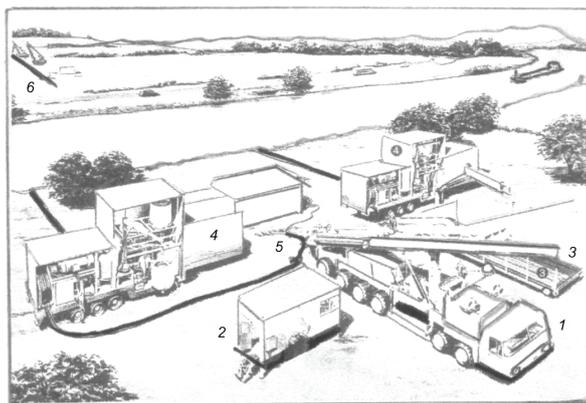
Бестраншейная прокладка трубопровода под рекой:
